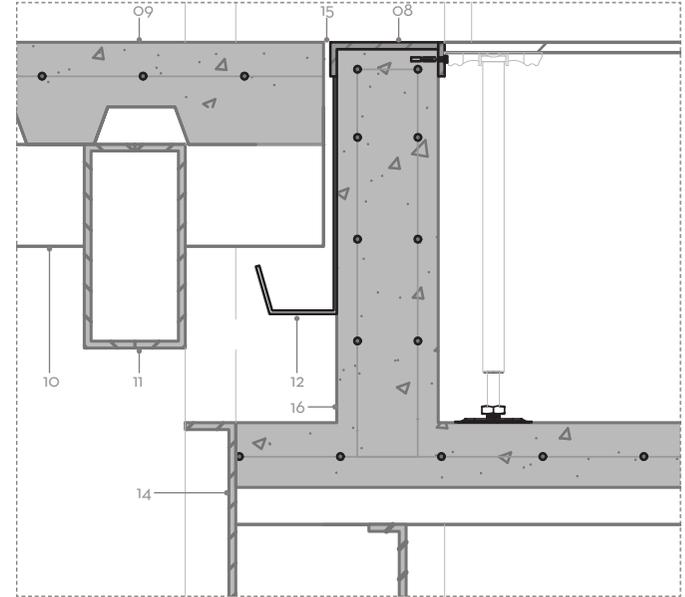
Det_e07. Junta entre Losa de vestibulo exterior y losa de piso técnico
